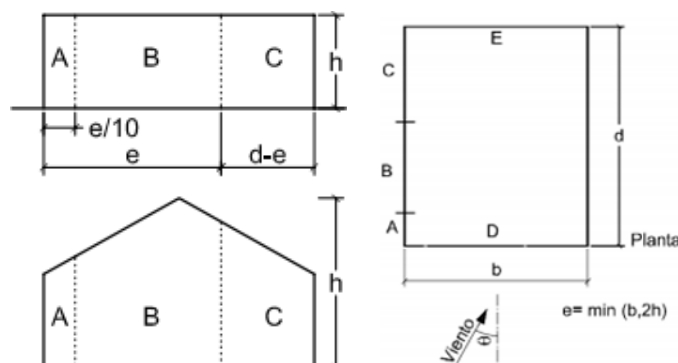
Áreas de influencia, en alzado y planta, de las fachadas verticales con viento a 90° [5]
